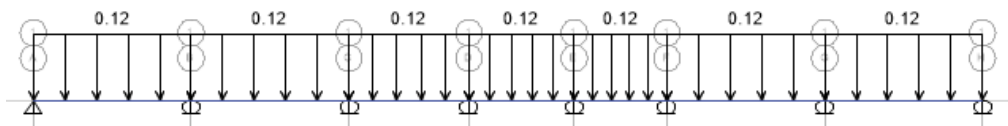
Carga muerta distribuida en vigueta de losa aligerada
